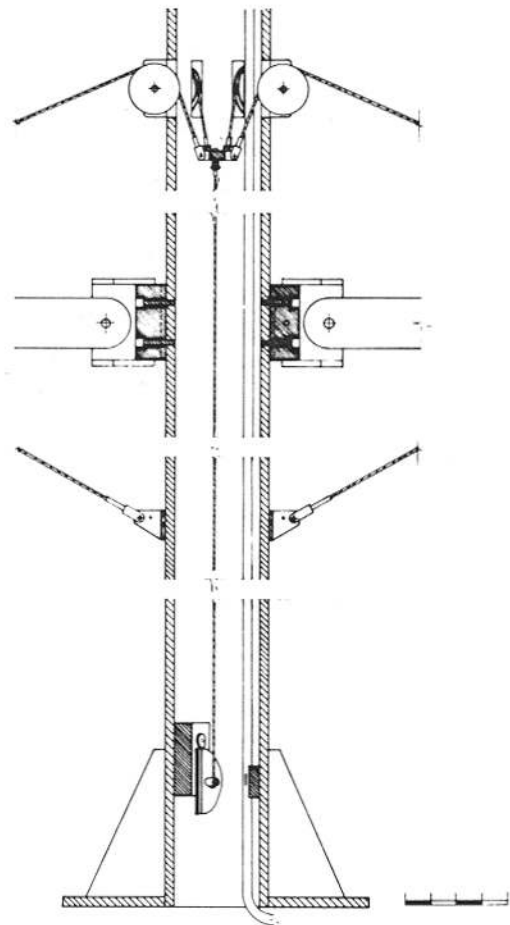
SECCION ATRAVEZ DE SOPORTE CENTRAL
